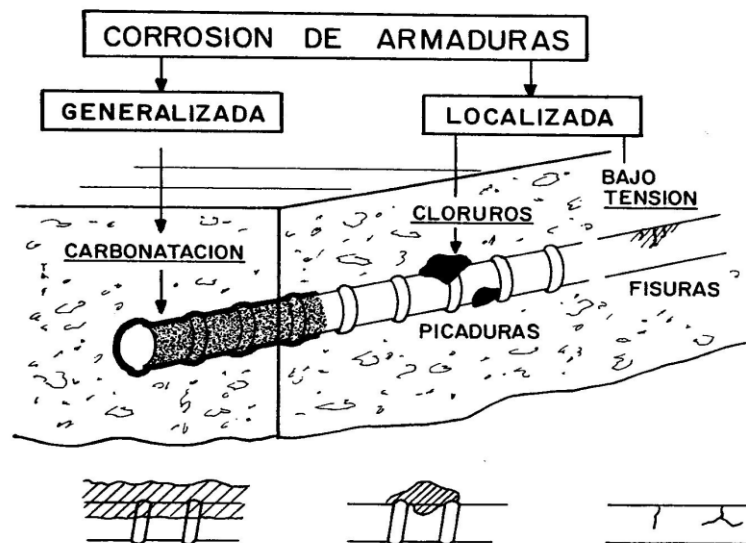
Tipos de corrosión de armaduras y factores que los provocan.
